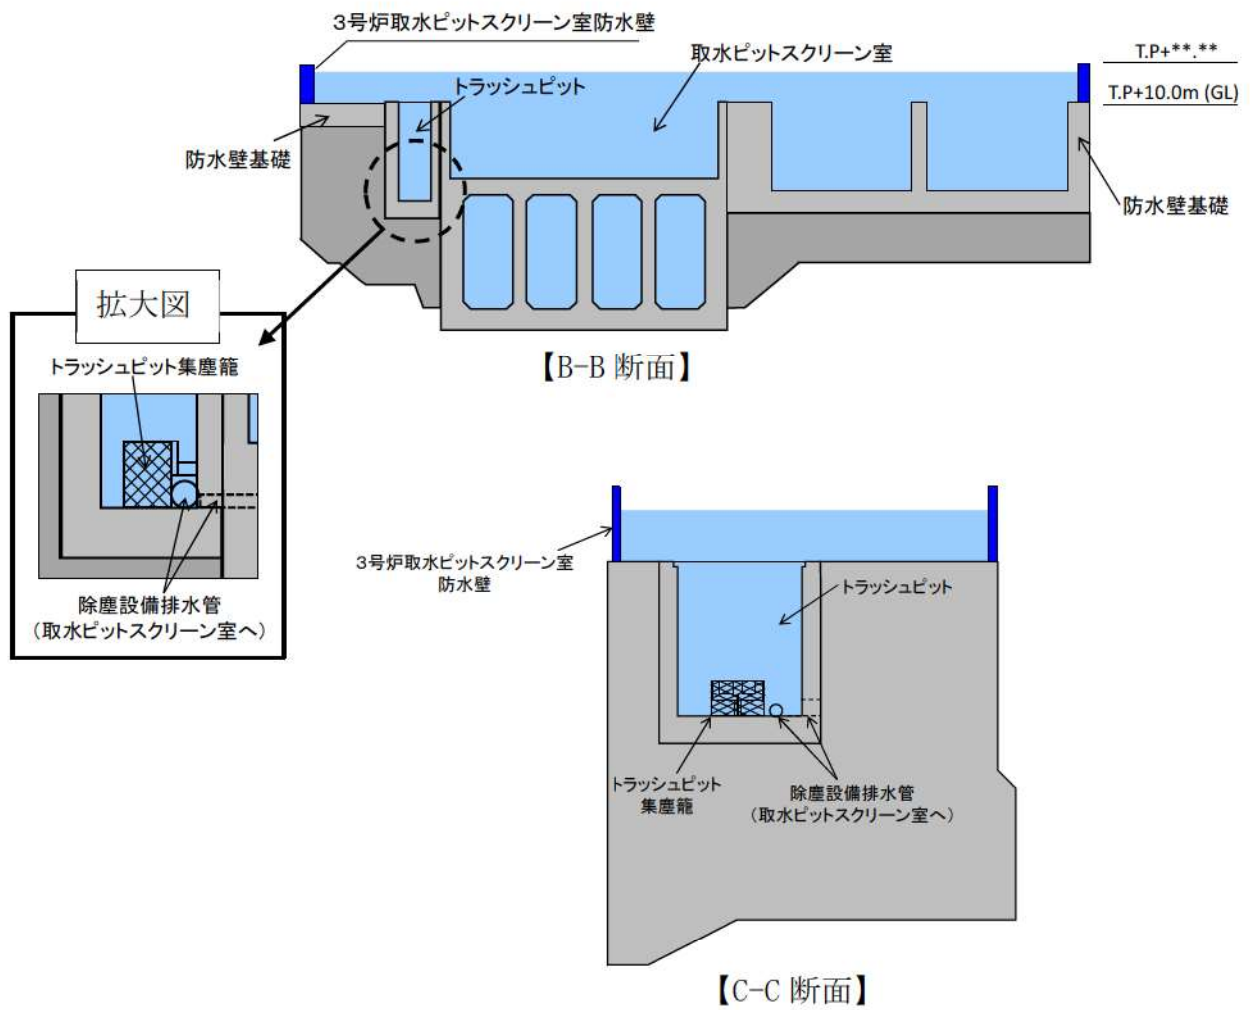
3号炉取水系統 流入対策配置図 (B-B, C-C 断面)
